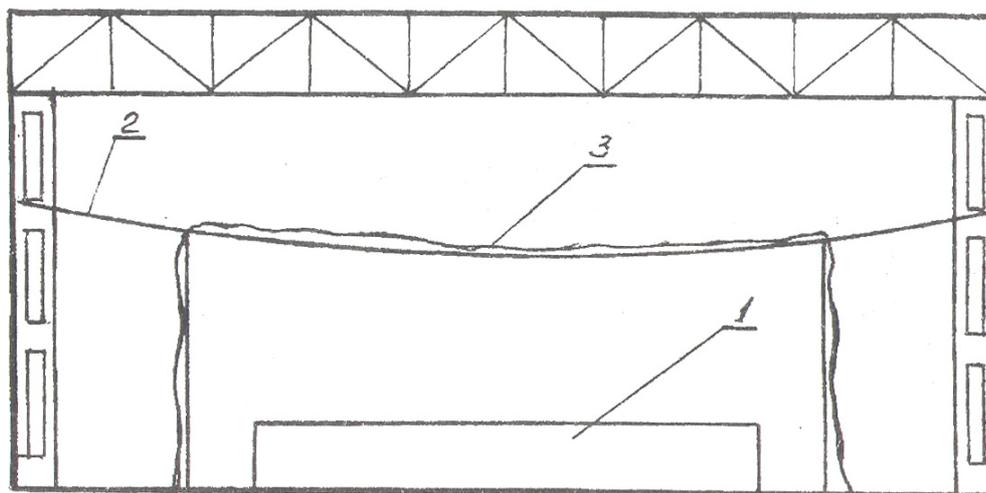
Тепляк из полиэтиленовой пленки для бетонирования фундамента под турбогенератор в зимнее время: 1 — фундамент; 2 — тросовая подвеска к каркасу; 3 — полиэтиленовая пленка
